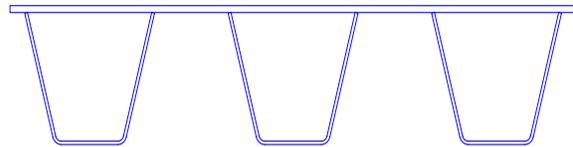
Ортотропная конструкция с закрытыми ребрами. Без нагрузки
